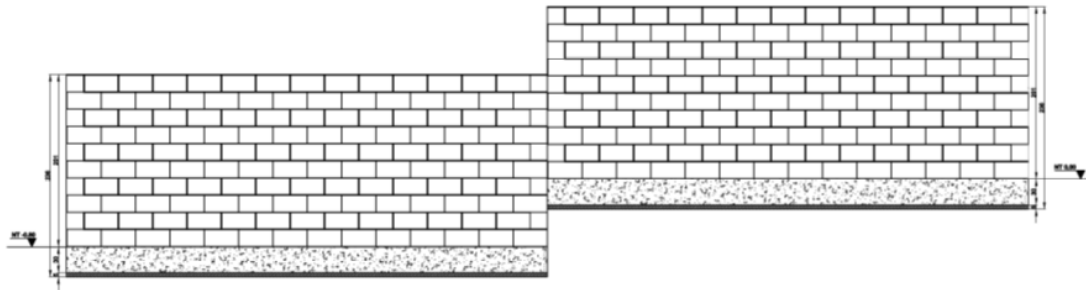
Diseño muro perimetral con bloques convencionales.
